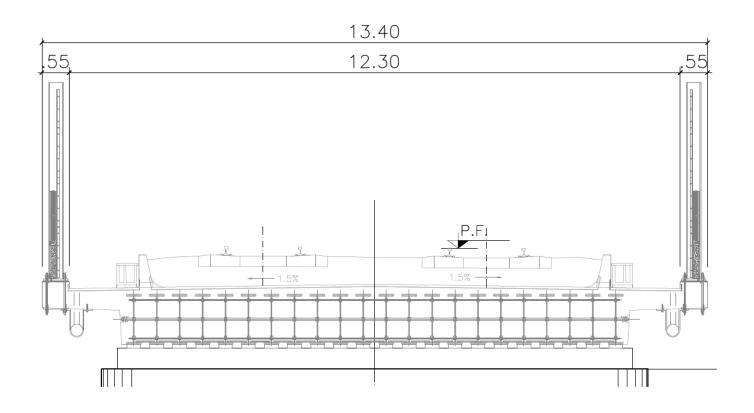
Sezione tipo - trasversale impalcato da 22,0m con travi incorporate.
